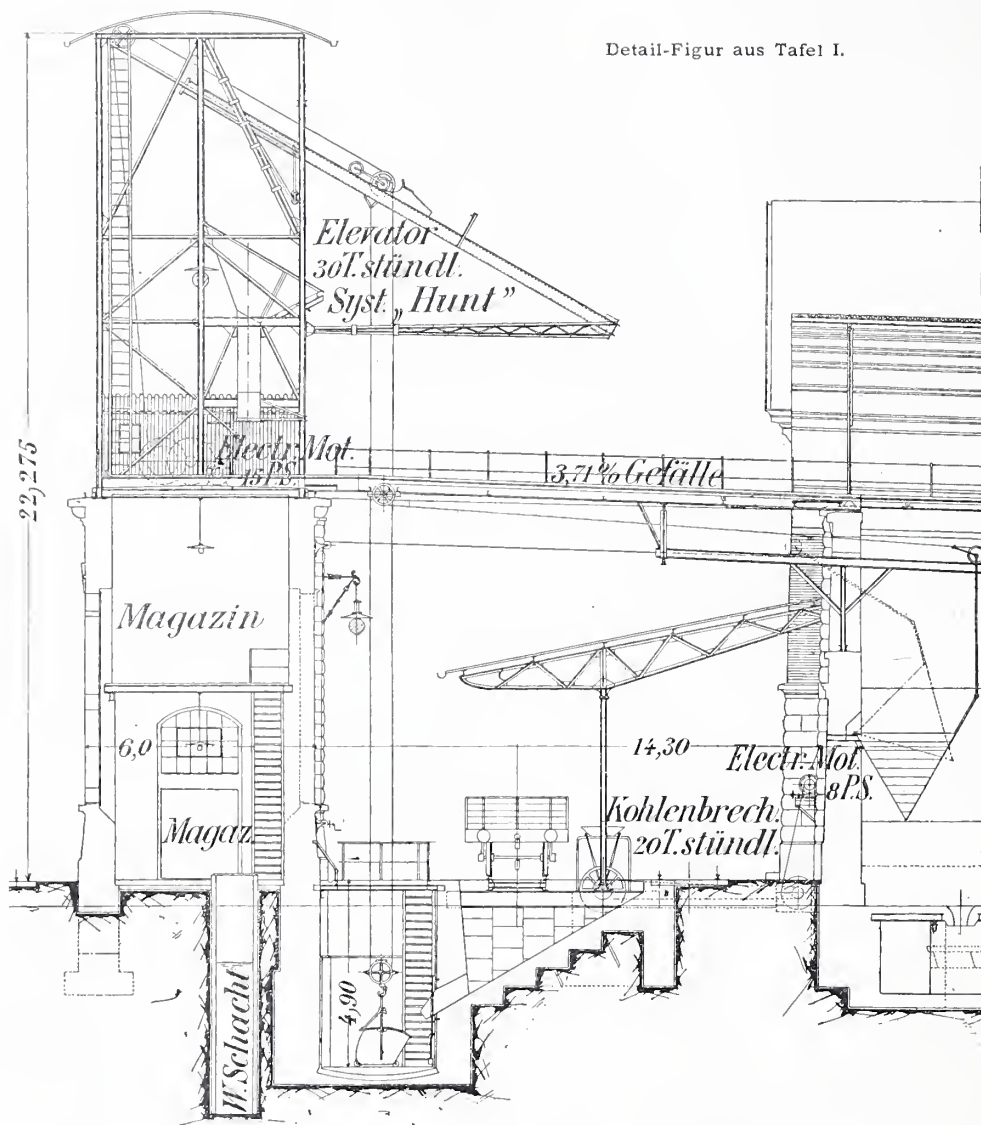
Querschnitt durch das Elevatoren-Gebäude mit Füllrumpf-Anlage 1:200.
